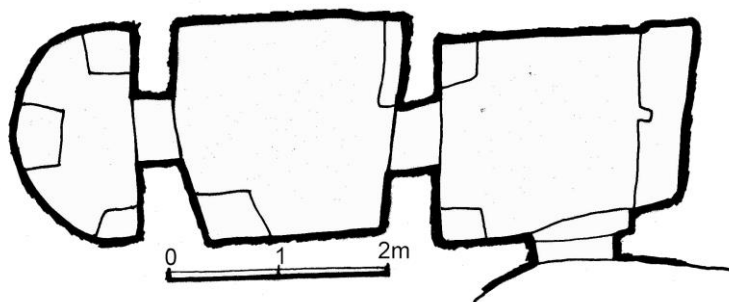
Plan de l'église rupestre B-1 (d'après I. Barnea).
